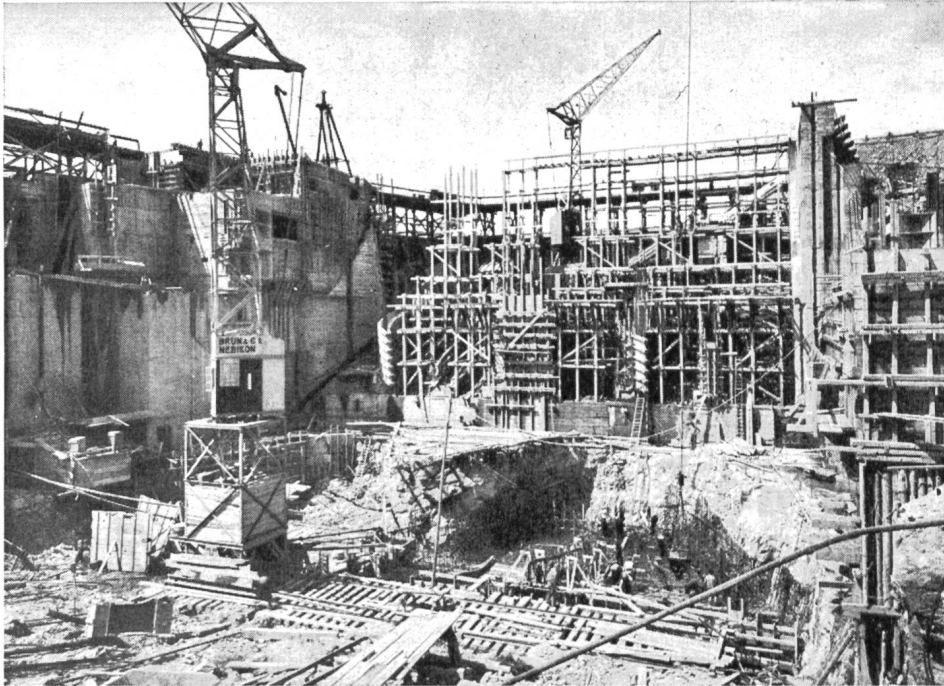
Maschinenhausbaugrube, Schalung Rechenvorbau, Armierung NOK-Krümmersohle.
